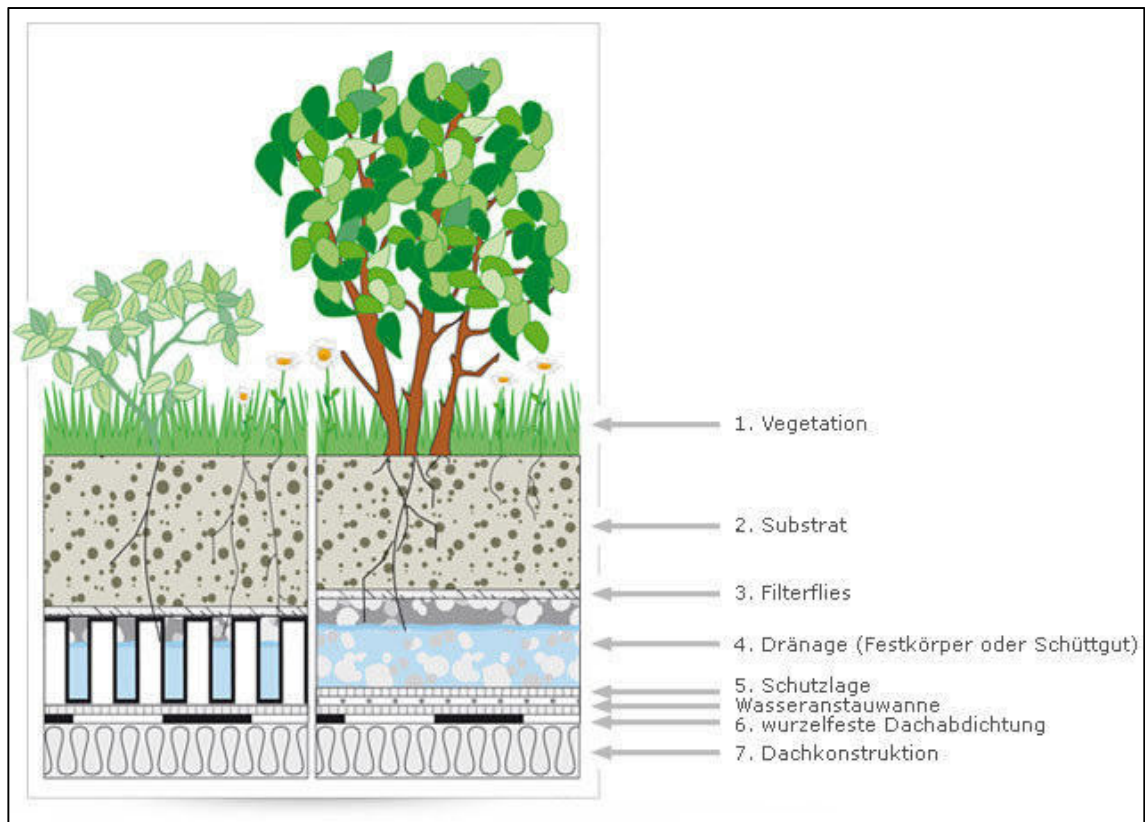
Intensive Dachbegrünung (Quelle: Bundesverband GebäudeGrün)
